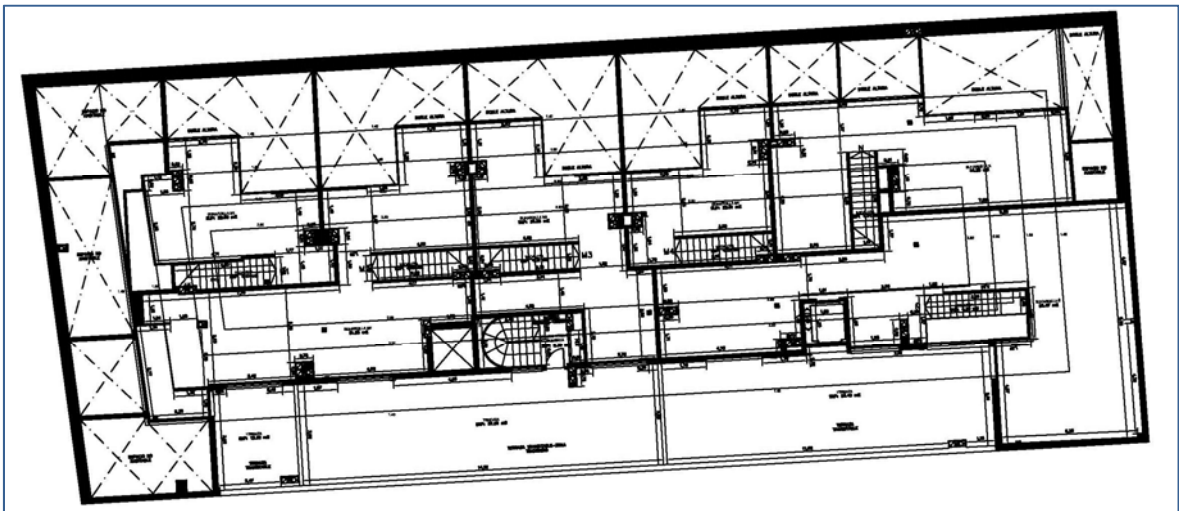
Plano de planta buhardilla. Procede del Proyecto de Ejecución.
